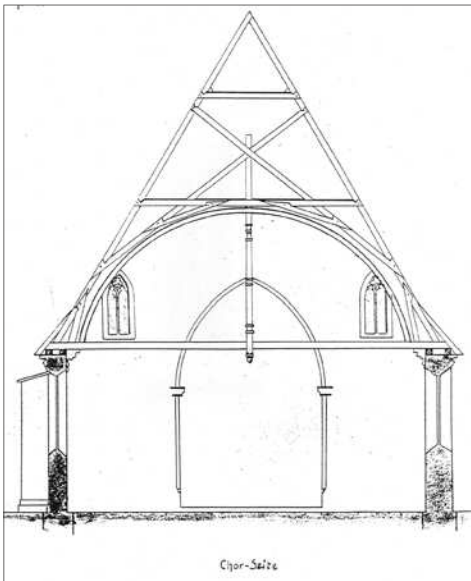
Stadtpfarrkirche, Querschnitt mit der Konstruktion des Daches,
